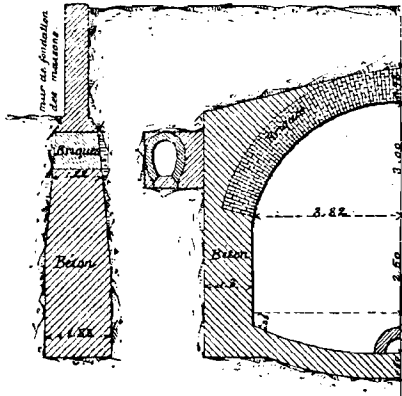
Demi-coupe transversale d'une partie de voie en tunnel dans le cas où l'on dispose d'une hauteur suffisante.
